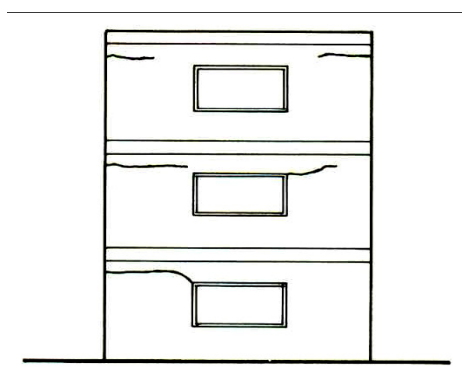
fissuras em paredes externas, causadas pela retração de lajes intermediárias (THOMAZ, 1989, p. 110)
